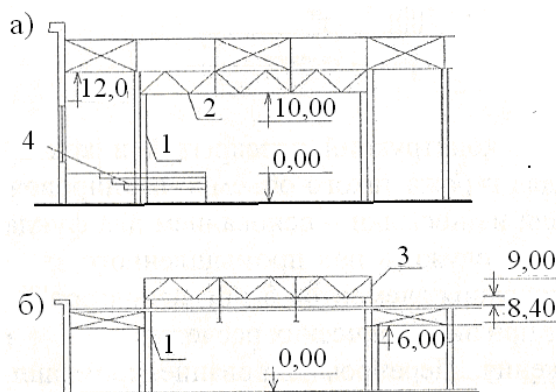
Схемы локального расширения пролета одноэтажного промышленного здания: а) установка подстропильных ферм ниже основного здания; б) установка подстропильных ферм выше основного здания; 1- дополнительные колонны, 2- подстропильные фермы, 3- дополнительные надстропильные фермы, 4- трибуны для зрителей
